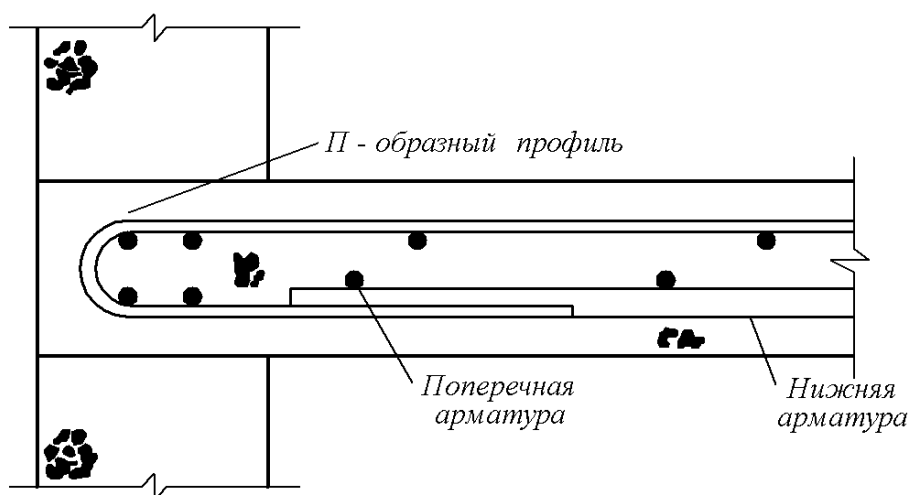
Плоская плита: армирование крайней опоры
